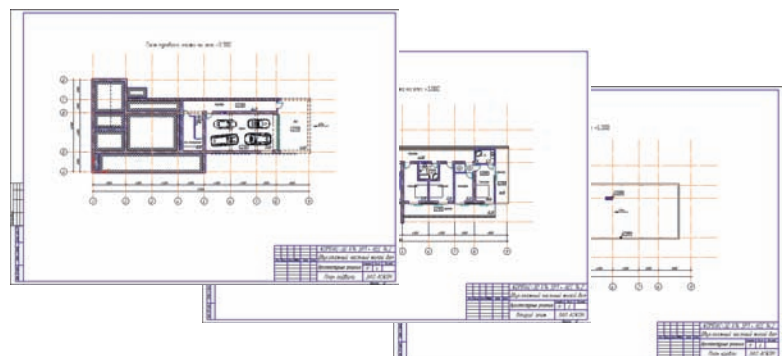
План нулевого (а), второго (б) этажей и кровли (в)
